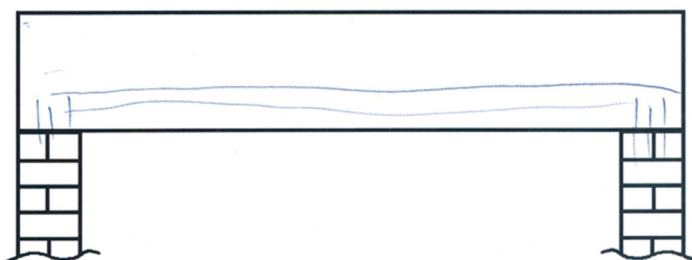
Schülerzeichnung 2 zur Lage der Bewehrung in einem Stahlbetonbalken (eigene Darstellung).
